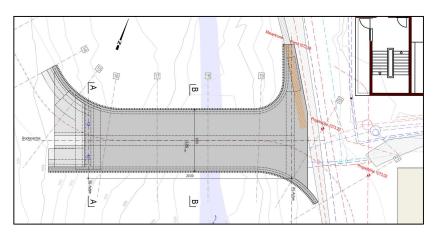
Grundriss geplante Brücke Val Buglina
